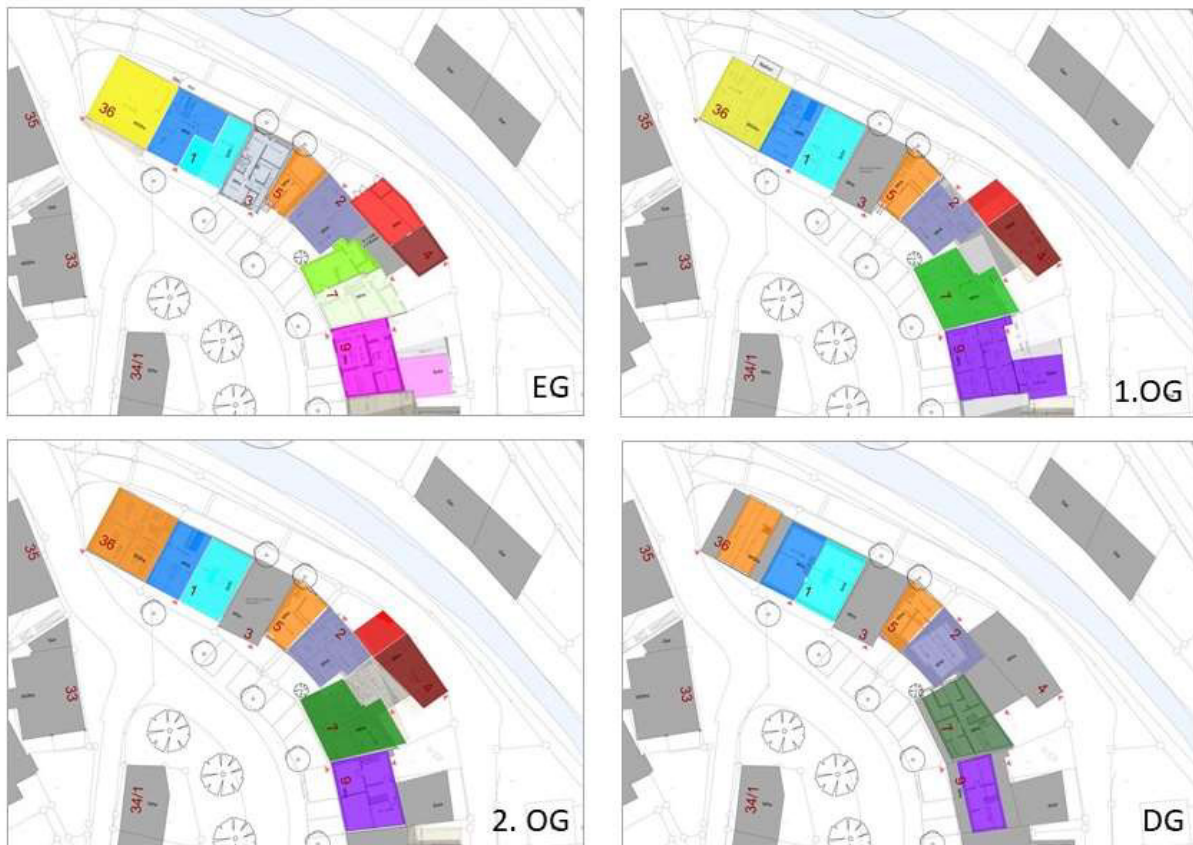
, Konzept Sanierung/Umbau Vordere / Hintere Seestraße
